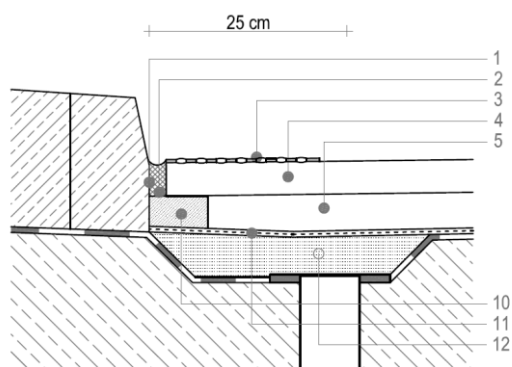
Hidroizolacija konstrukcije uz rub kolovoza
